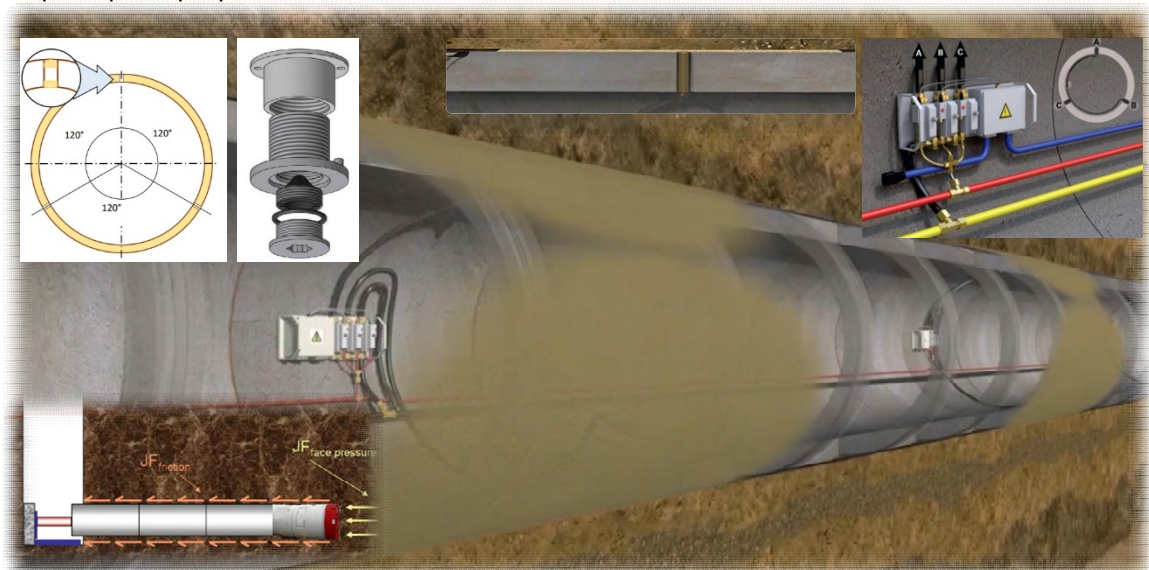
Aplicación de Slurry para mejora de fricción entre tubería y terreno. Herrenknecht 2025.
